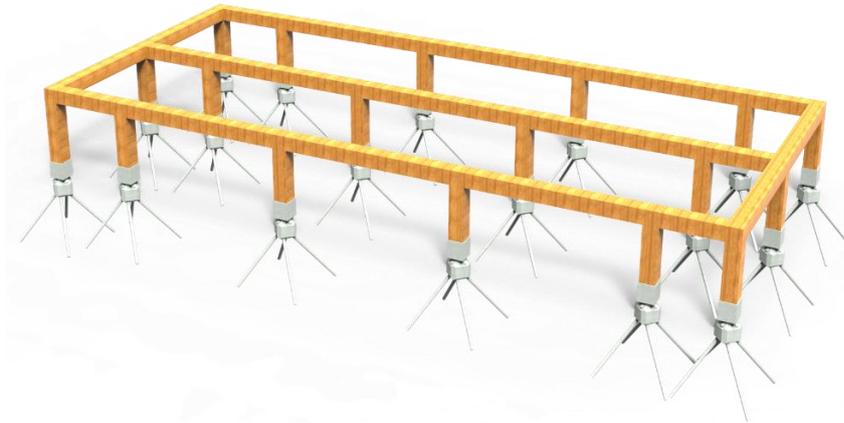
Instalación de Piloedre. Piloedre.es
